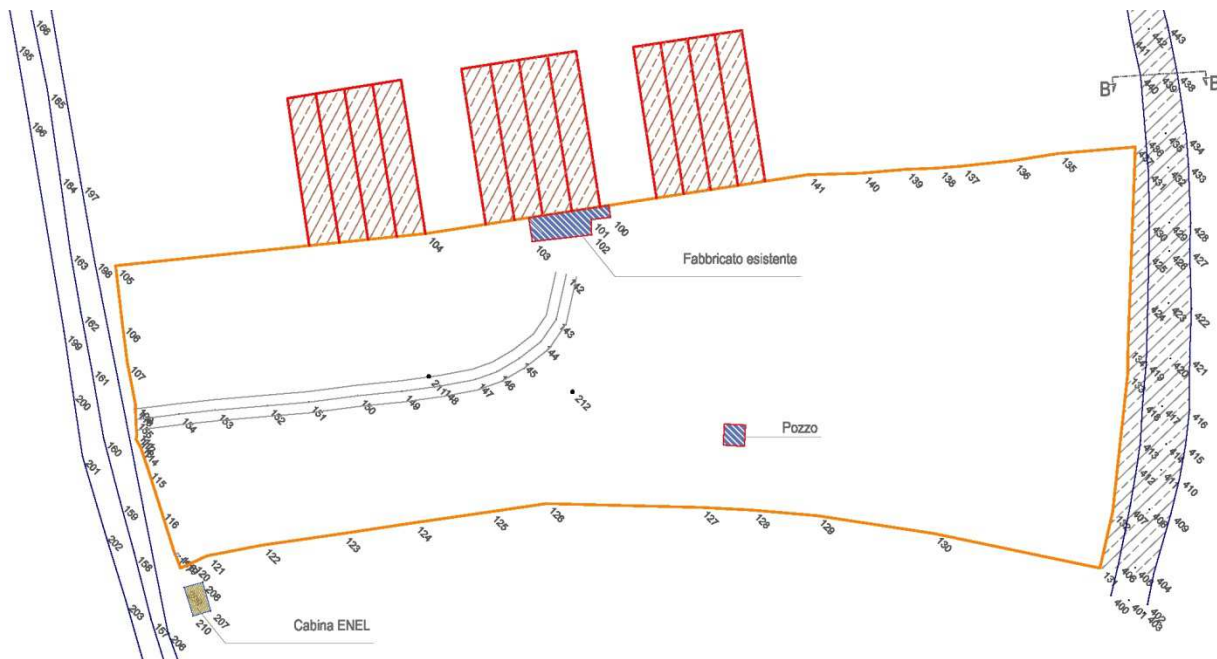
Planimetria di rilievo della lottizzazione – Stato Attuale
